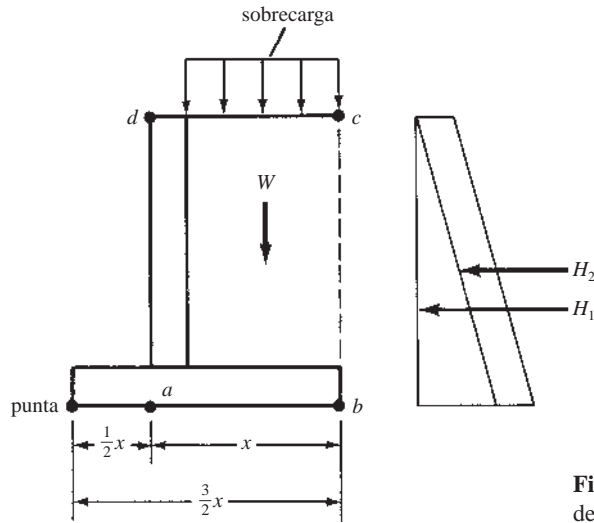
Fuerzas que actúan sobre un muro de retención tipo voladizo.
